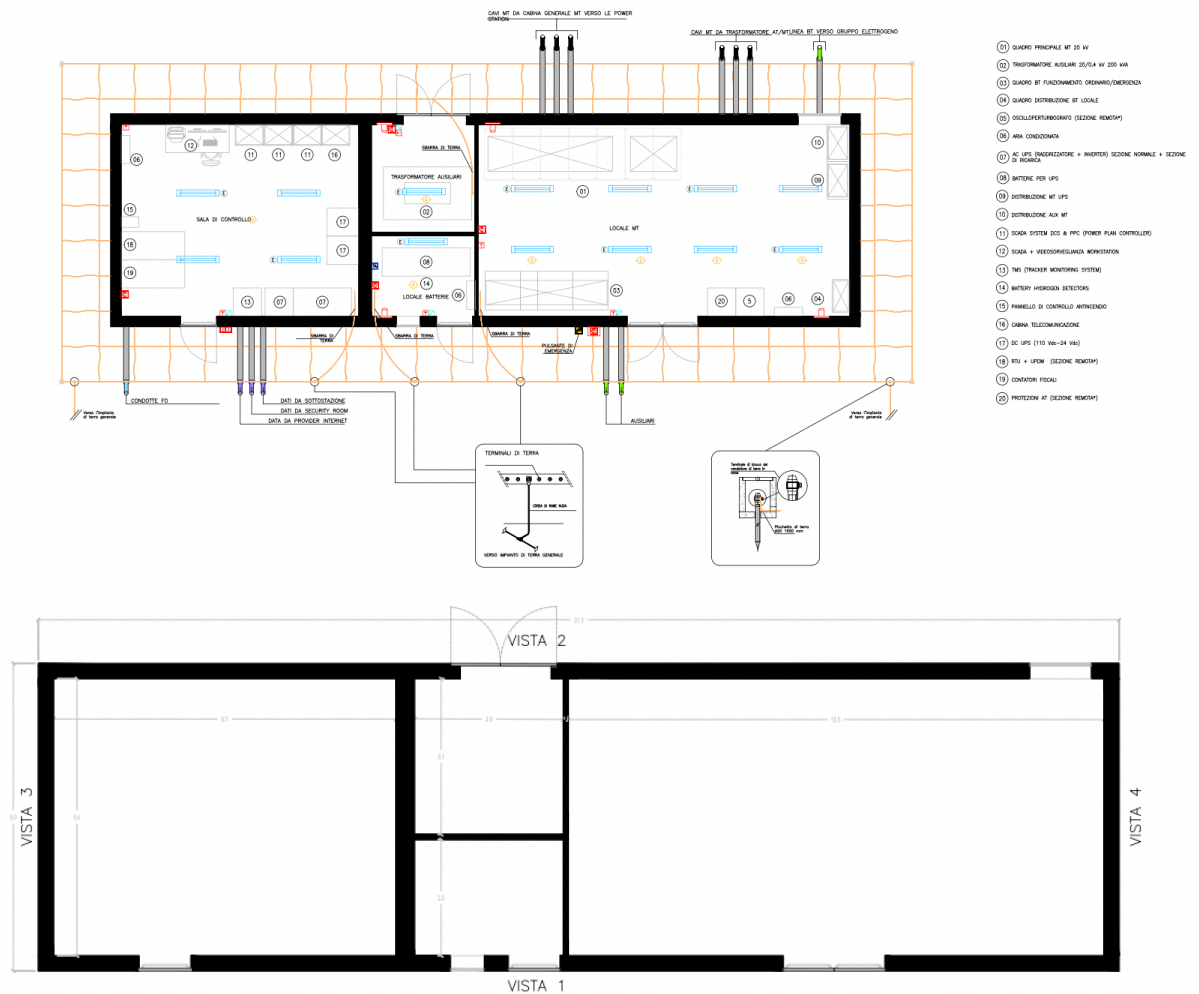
Pianta e prospetto del manufatto contenente la cabina MT
